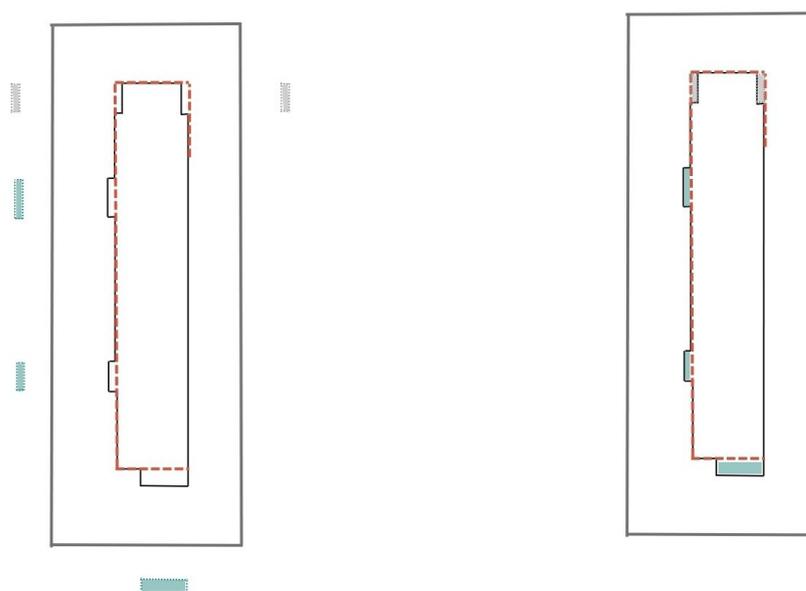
Renato B. de Melo – implantação - subtrações em cinza e adições em azul na planta. Fonte: Adrião, 2024.
